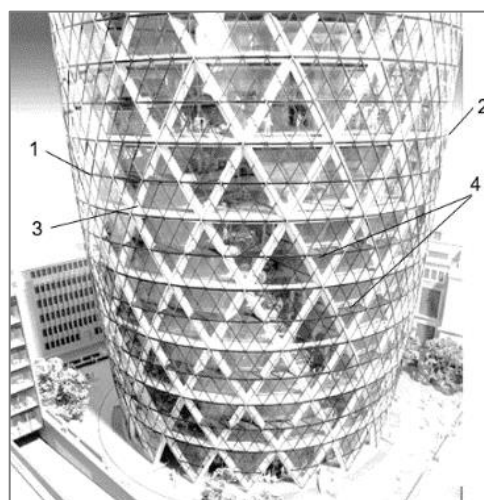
Металлический каркас системы «Diagrid»: 1-кольцевые балки, соединенные с плитой перекрытия; 2-кольцевая балка межэтажная; 3-узлы; 4-наклонные элементы [6]
